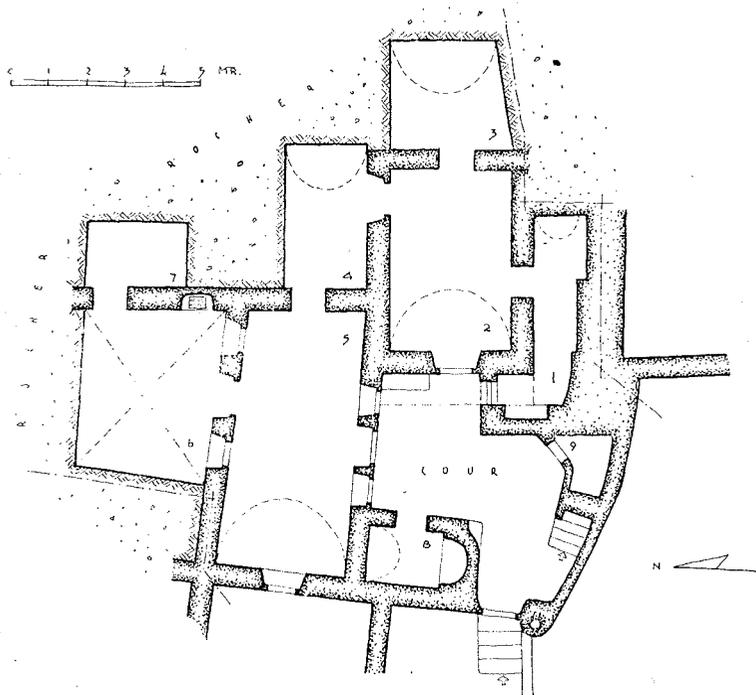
Maison à Ia (Santorin). Plan du rez-de-chaussée
